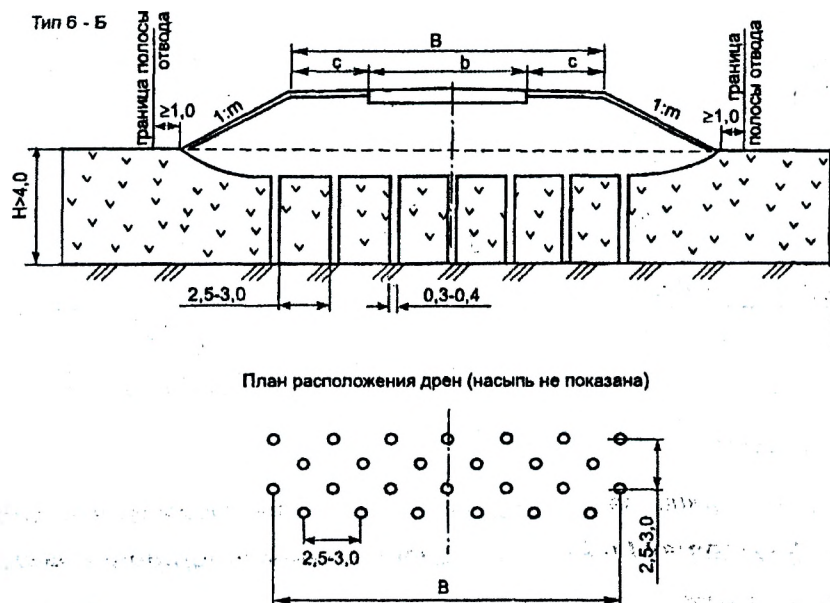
Типовая конструкция земляного полотна на болоте с вертикальными дренами
